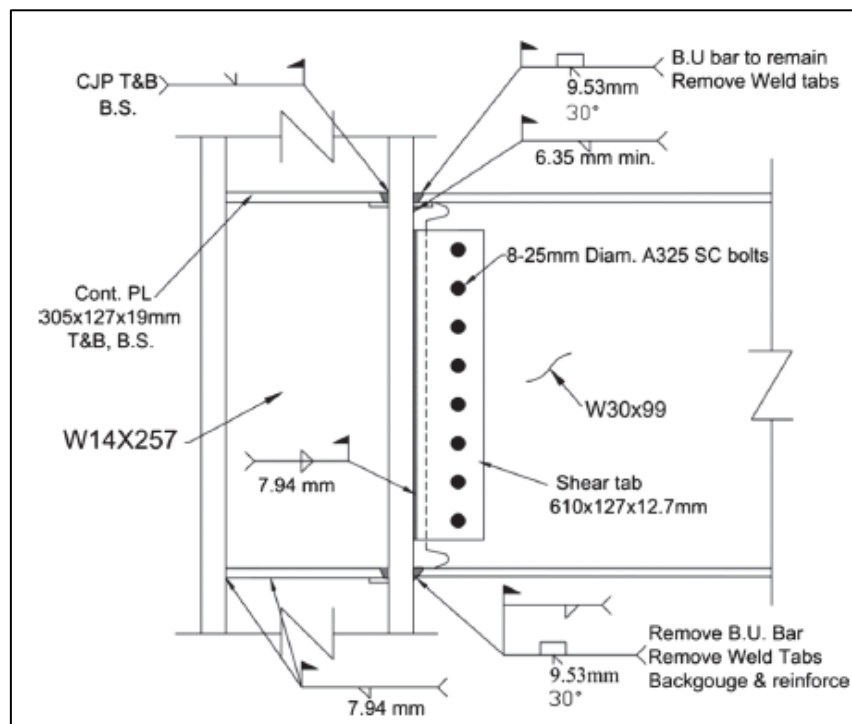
Detalle típico de perforación de acceso en unión Viga – columna.
